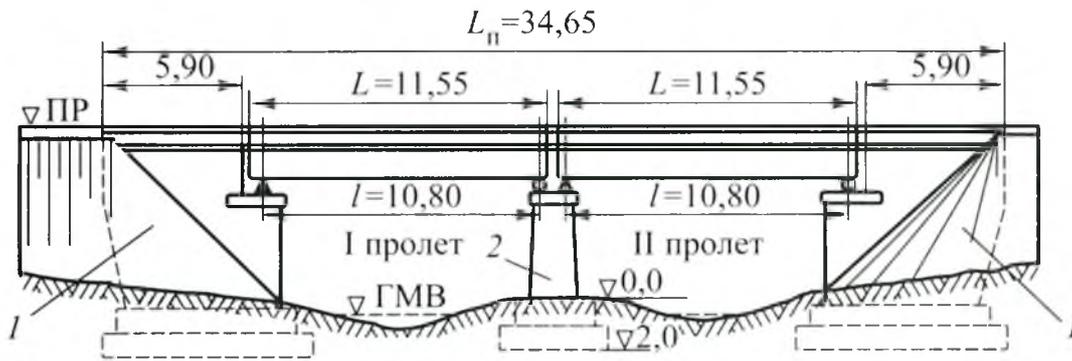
Общий вид железобетонного моста (двухпролетного):
